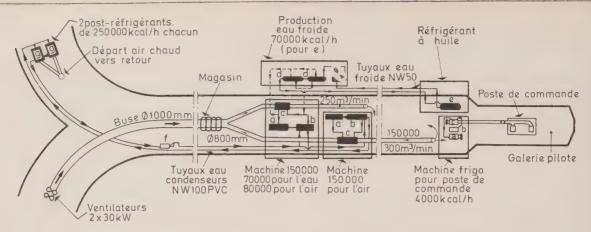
Disposition des machines frigorifiques dans le creusement mécanisé, étage 10
